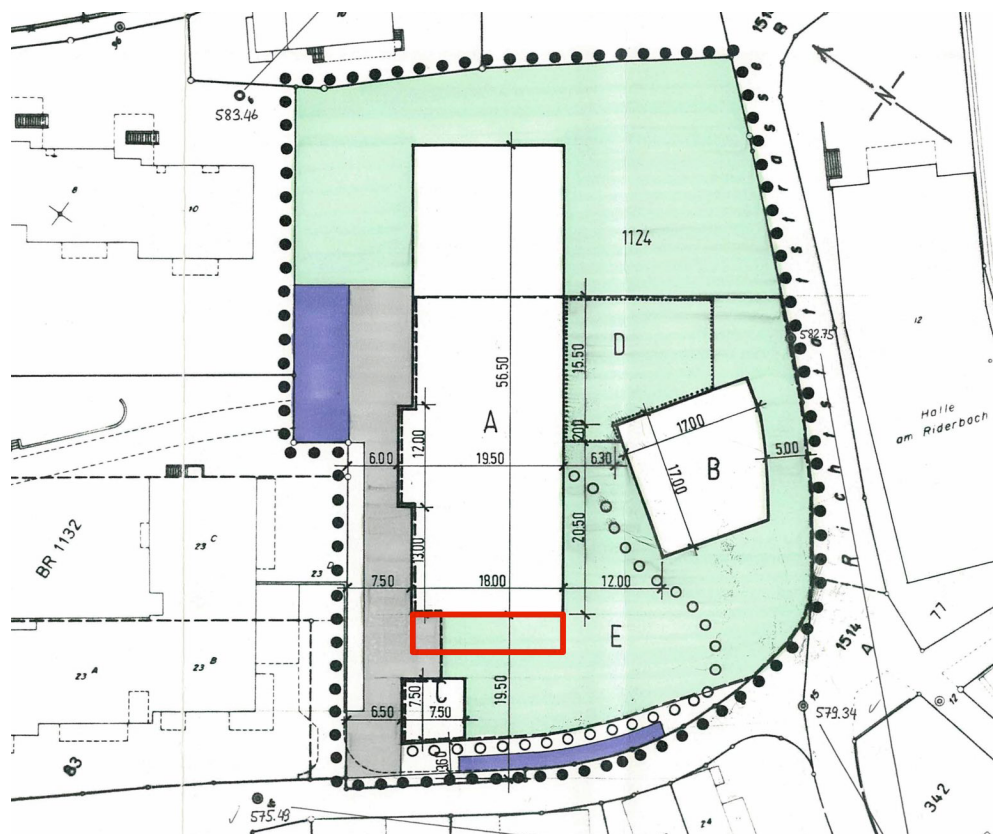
Ausschnitt bestehender Überbauungsplan mit Änderungsperimeter [Lohner + Partner AG]
